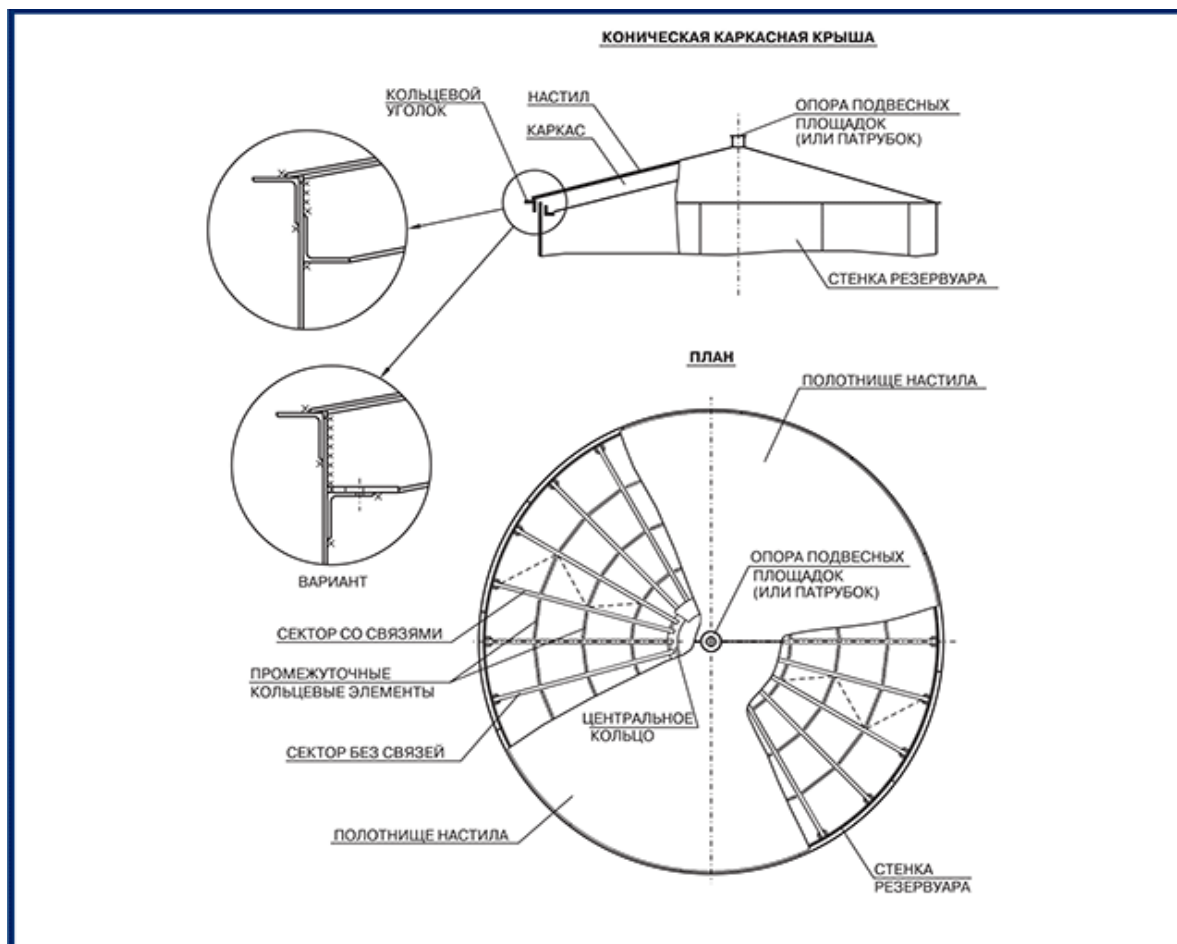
Конструкция каркасной крыши конической резервуара РВС-3000
